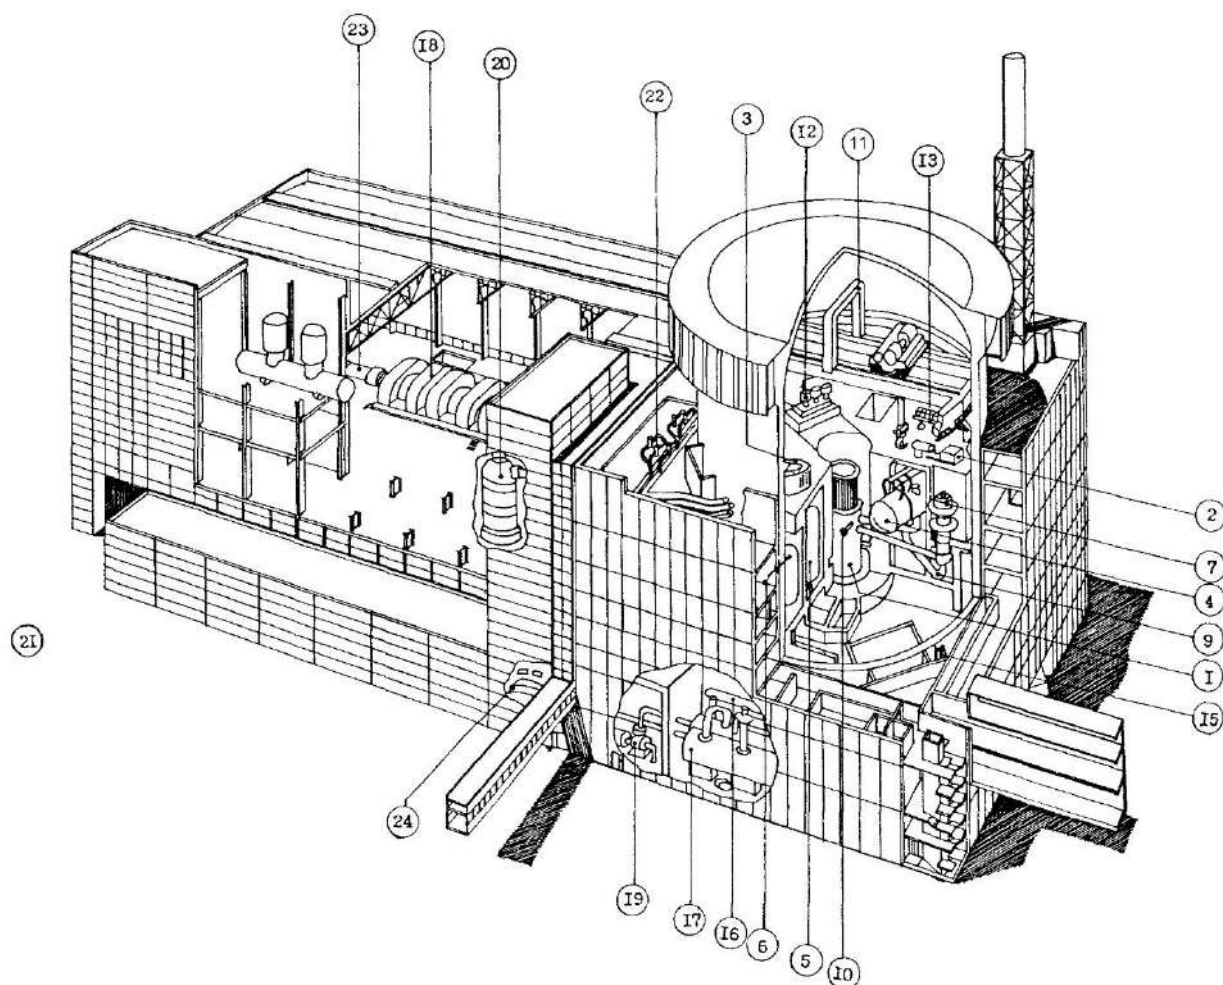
Главный корпус серийного блока АЭС с ВВЭР-1000 (аксонометрия):
